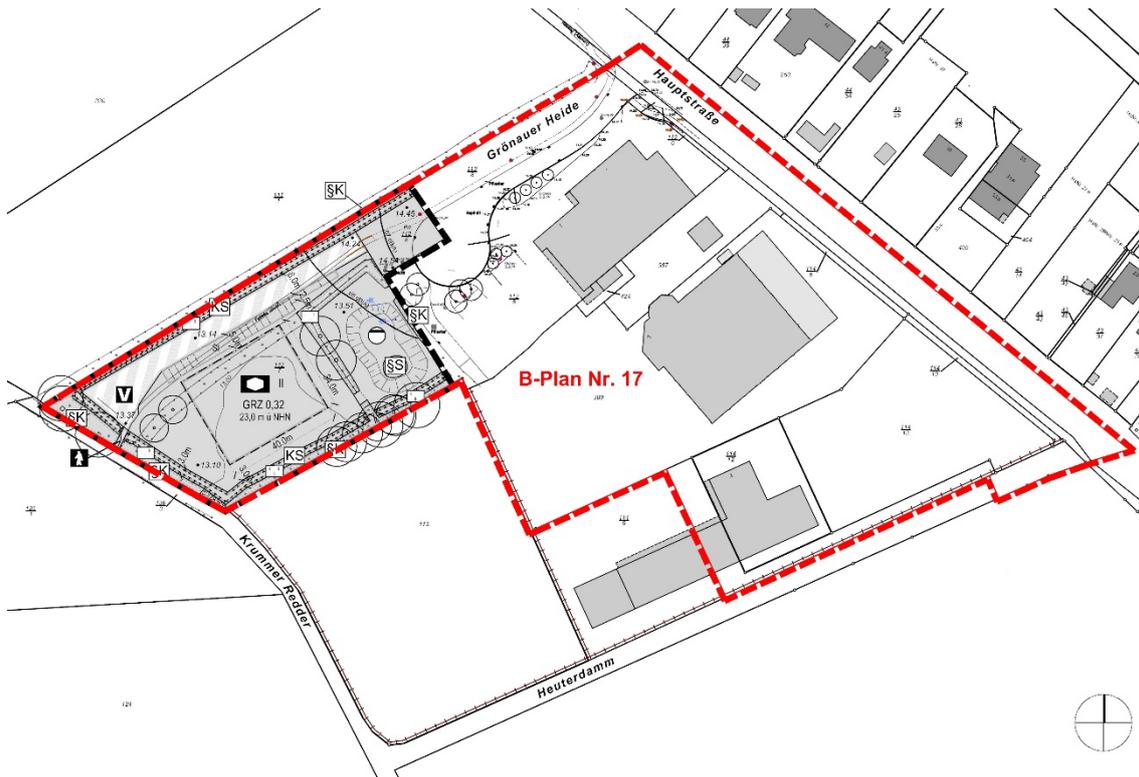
Überlagerung des bestehenden (Bebauungsplan Nr. 17) und künftigen Planungsrechtes
